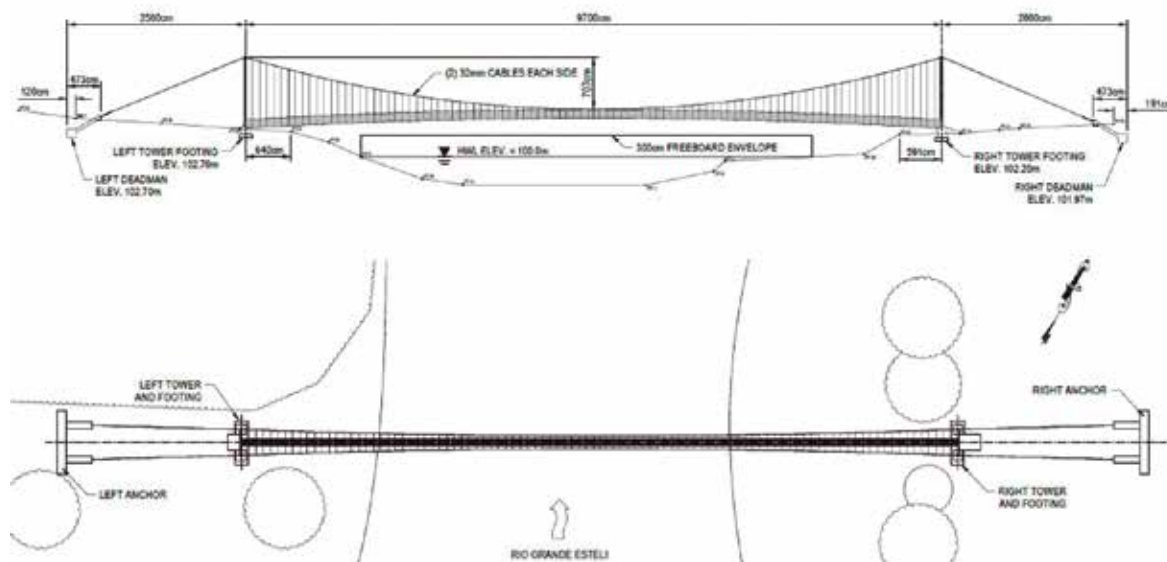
Alzado y planta general de la Pasarela Monte Verde
